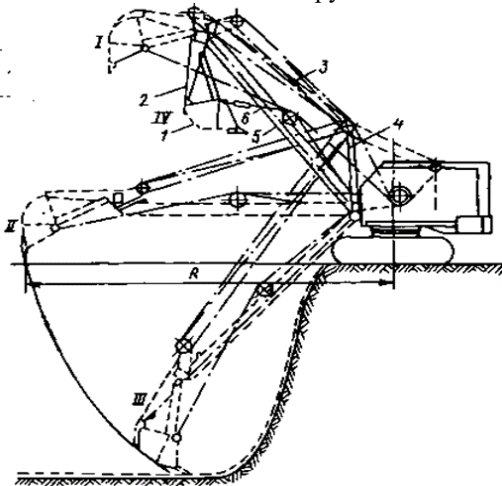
Конструктивная схема экскаватора с обратной лопатой: I — разгрузка; II — опускание; III — подтягивание; IV — перед разгрузкой; 1 — ковш; 2 — рукоять; 3, 6 — подъемный и тяговый полиспасты; 4 — стойка; 5 — стрела [4]
